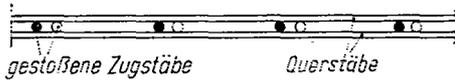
Beispiel für einen Übergreifungsstoß geschweißter Betonstahlmatten ohne Anrechnung von Querstäben (Querschnitt)
